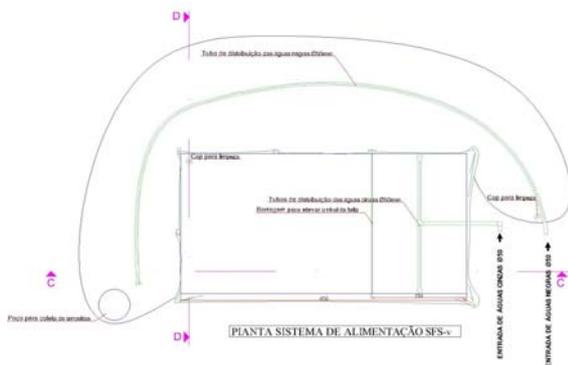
Planta baixa dos dois sistemas (retangular água cinza, ovalado água negra)
